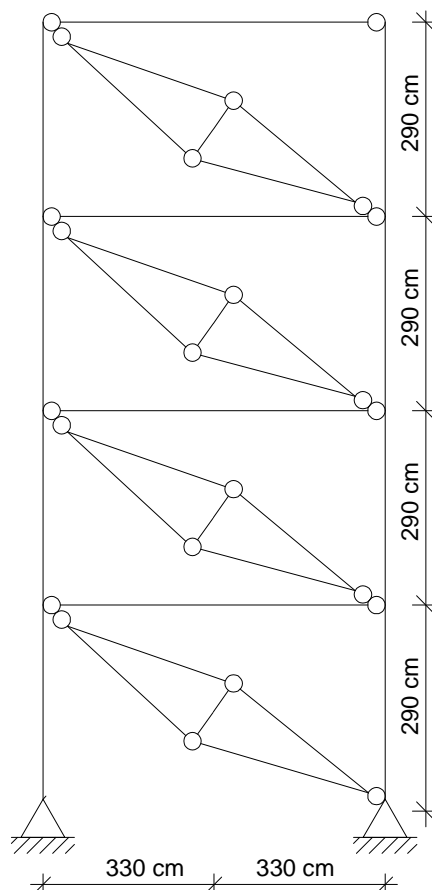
Pórtico plano de quatro pavimentos (caso B1) com substituição dos contraventamentos metálicos pelo modelo de bielas e tirantes.
